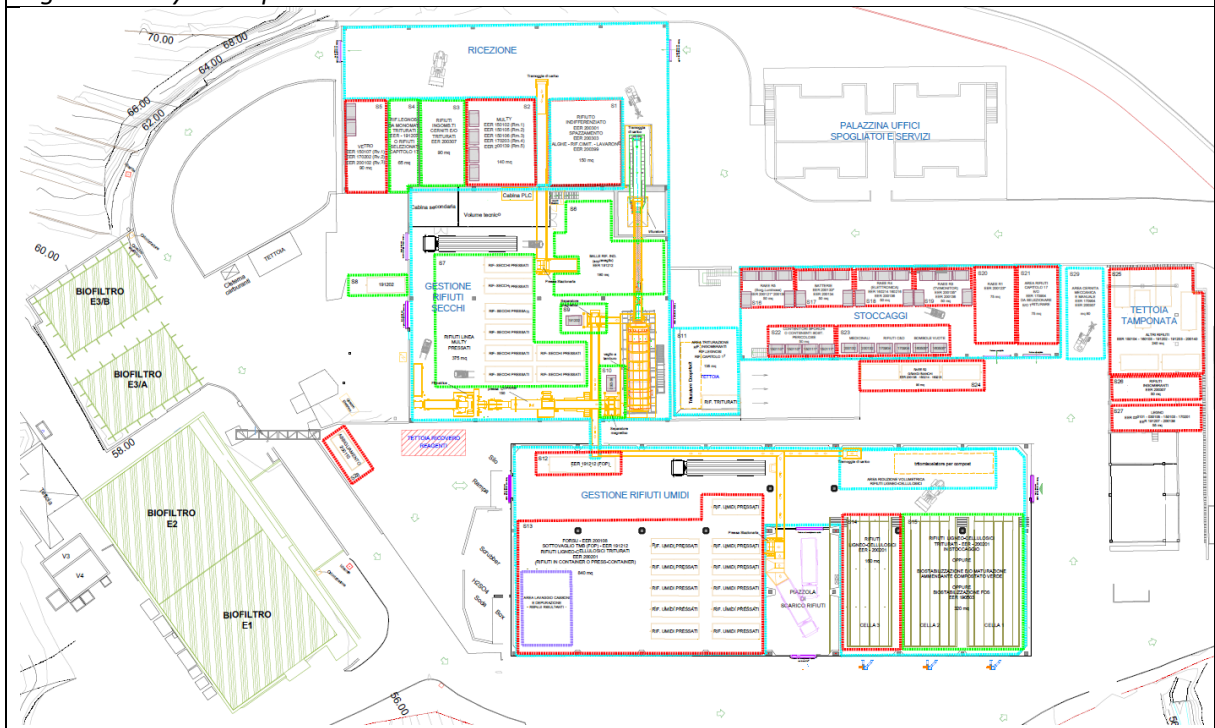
Layout impiantistico e aree di stoccaggio nello stato di progetto
